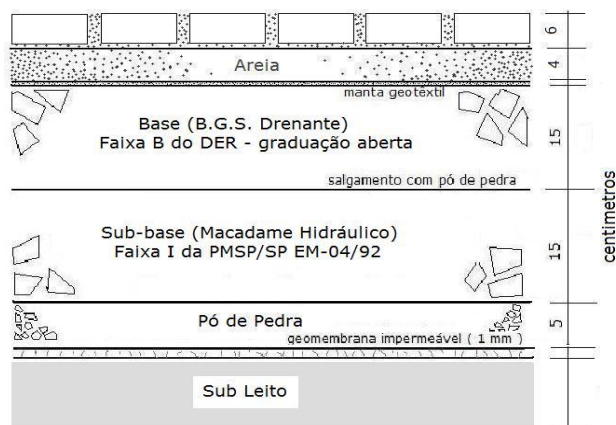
perfil do pavimento com blocos intertravados de concreto poroso
